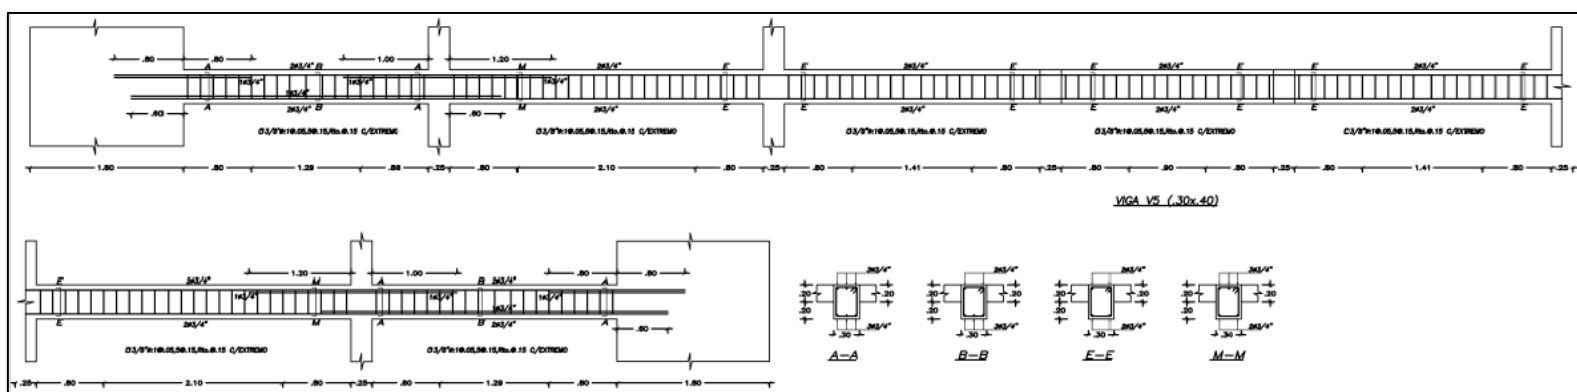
Armado de acero de la viga V-5 (0.30x0.40m)
